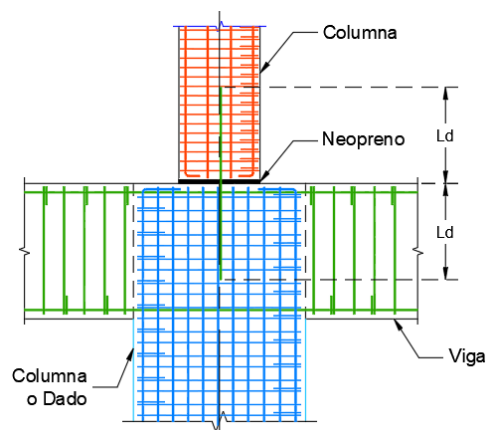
c – Conexión a cimentación de una columna articulada.
